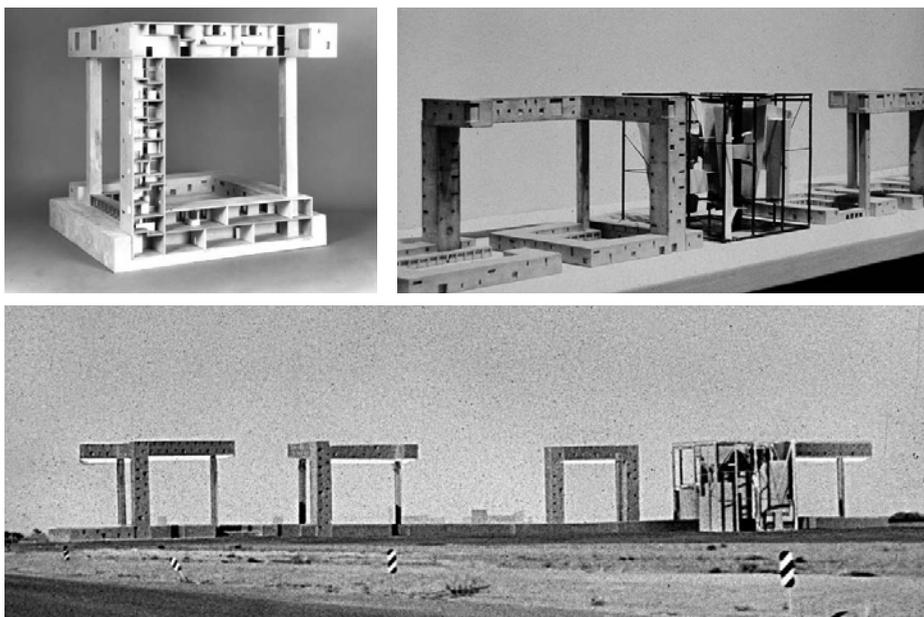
e 29 - S.Holl, Progetto per le "Spatial retaining Bars", Phoenix - Arizona. Immagine tratta da S. Holl, *Urbanisms - Lavorare con il dubbio* (op. cit.). Foto dei modelli, fotomontaggi e planimetria urbana
